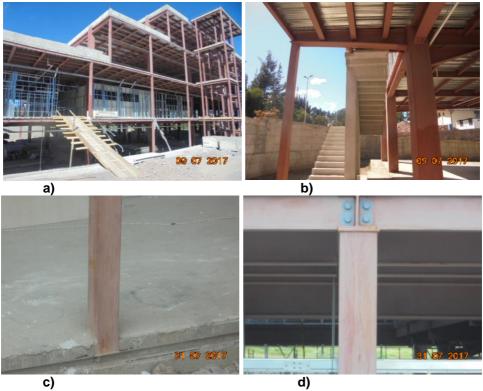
Apoyos, bajo los voladizos; a) Bloque Arquitectónico 1; b) Viga principal de sección variable y columnas; c) Detalle de la columna de apoyo en el nudo inferior; d) Detalle del apoyo en el nudo superior.
